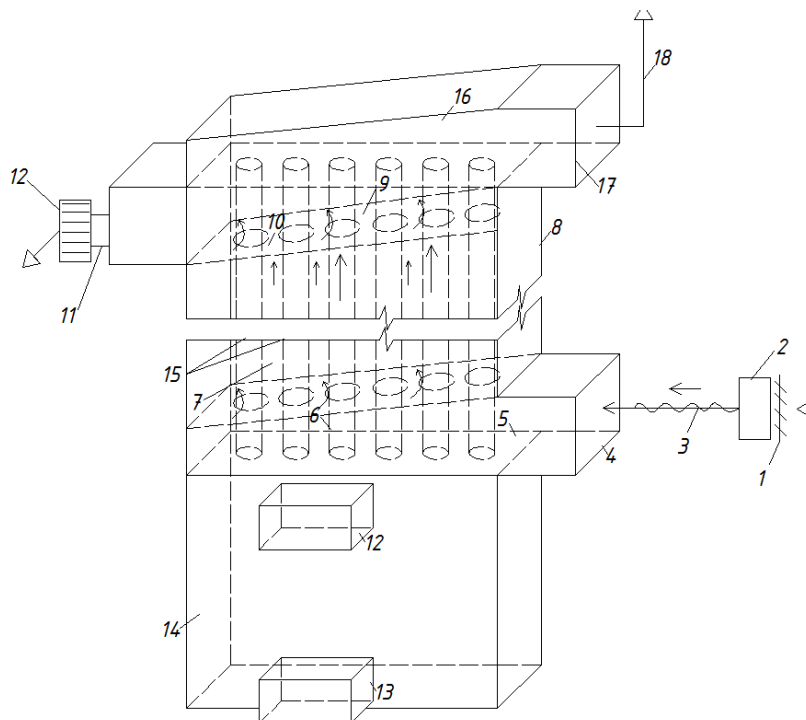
Схема тепловой вентиляции газифицированных кухонь
